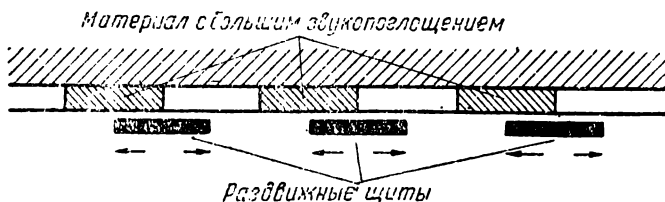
Схема устройства переменной реверберации с раздвижными щитами
